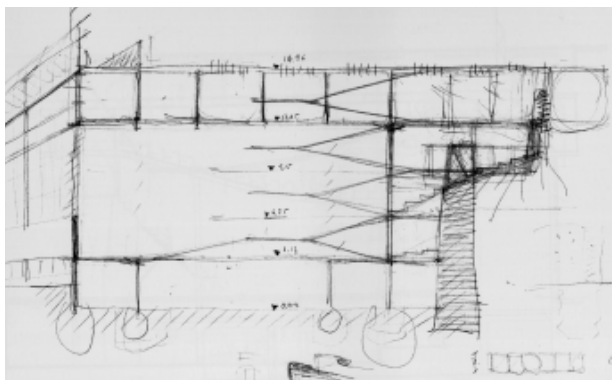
Croquis de Sota de la sección transversal del Gimnasio Maravillas con viga Viereendel.
